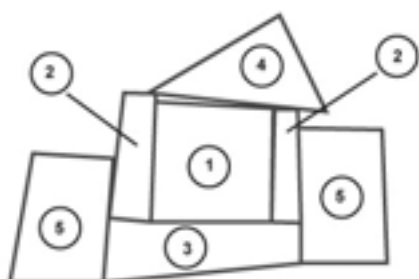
Exemple de plan d'édifice gravé sur pierre (*forma urbis*)
